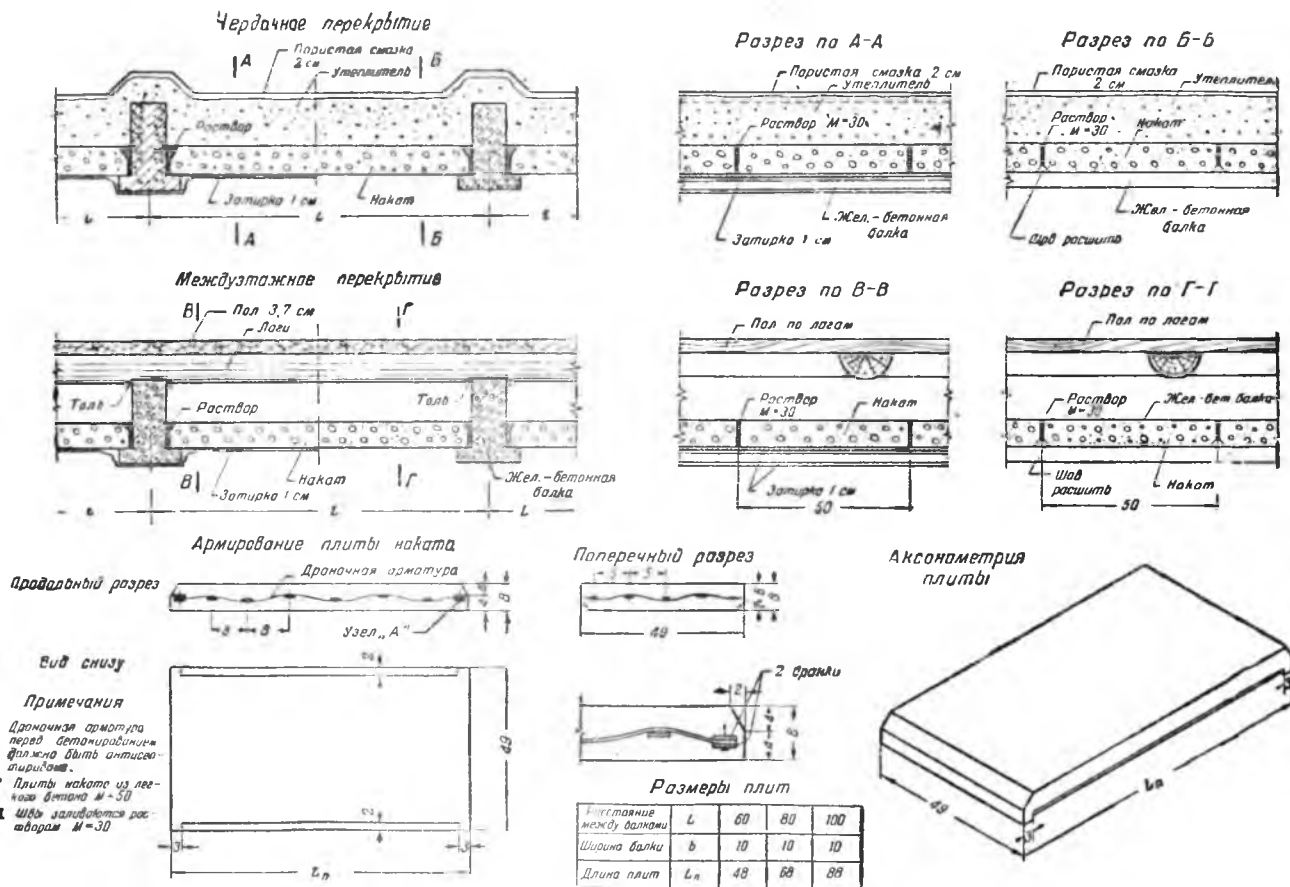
Перекрытие с несущим накатом и выступающими железобетонными балками
